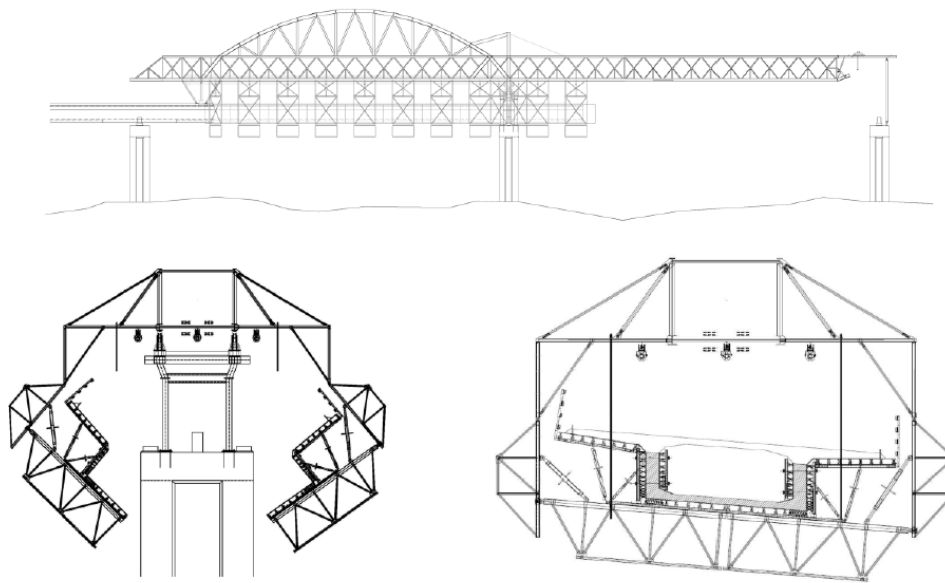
Esquema da construção tramo a tramo com recurso a viga de lançamento superior [12]
